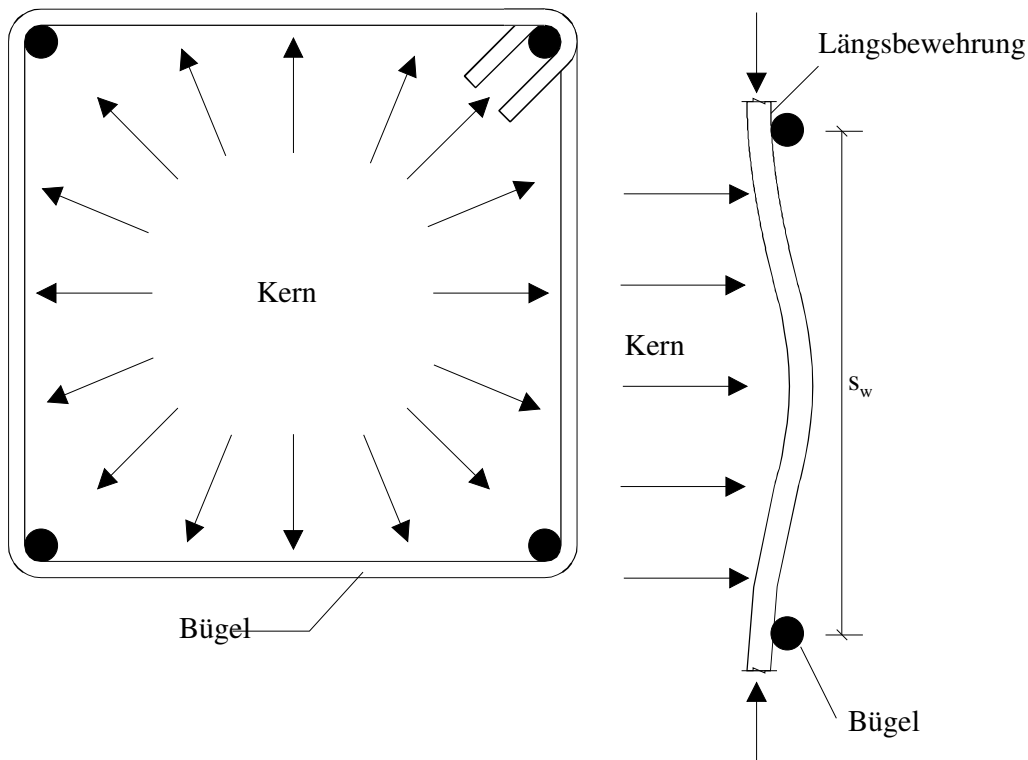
Querbeanspruchung der Längsbewehrung durch den aus Querdehnung nach außen drängenden Beton [29]
